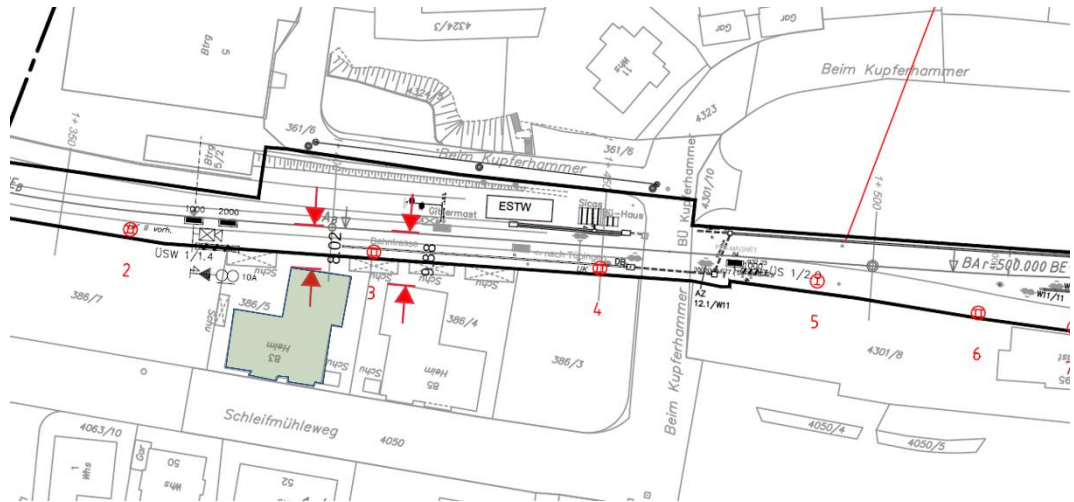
Ausschnitt aus dem Lageplan „Tübingen-West“ [15]
